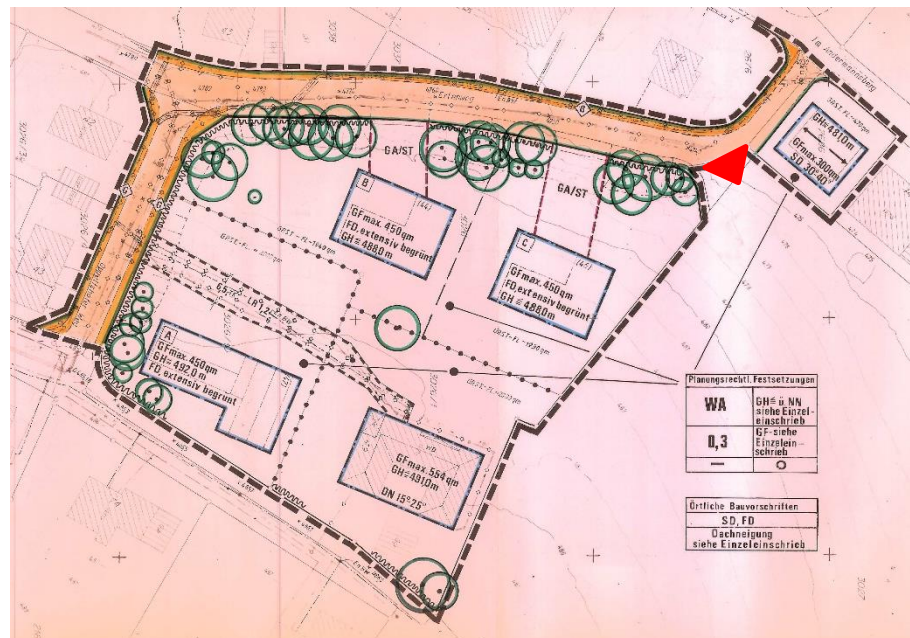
Bebauungsplan Oppeltshofer Weg/Erlenweg. Quelle: Stadt Ravensburg. Der rote Pfeil markiert die geplante Gebietseinfahrt
